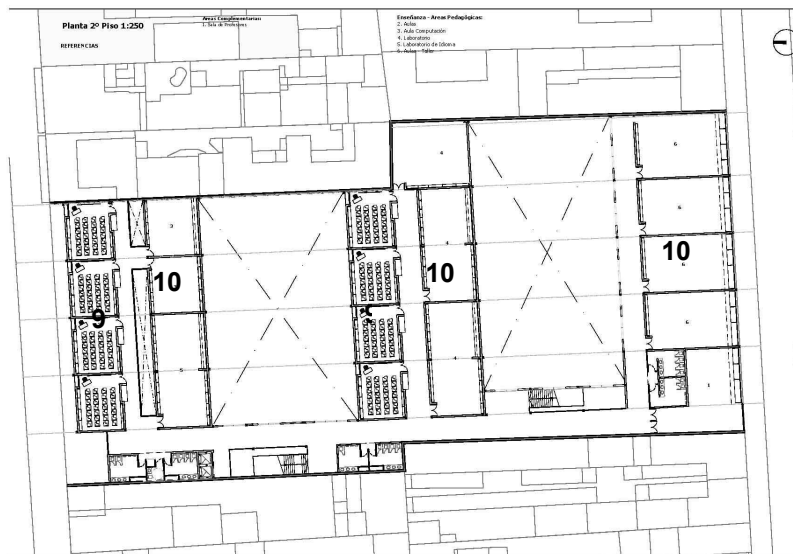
Planta 2º Piso (Nivel +6,80 m)
